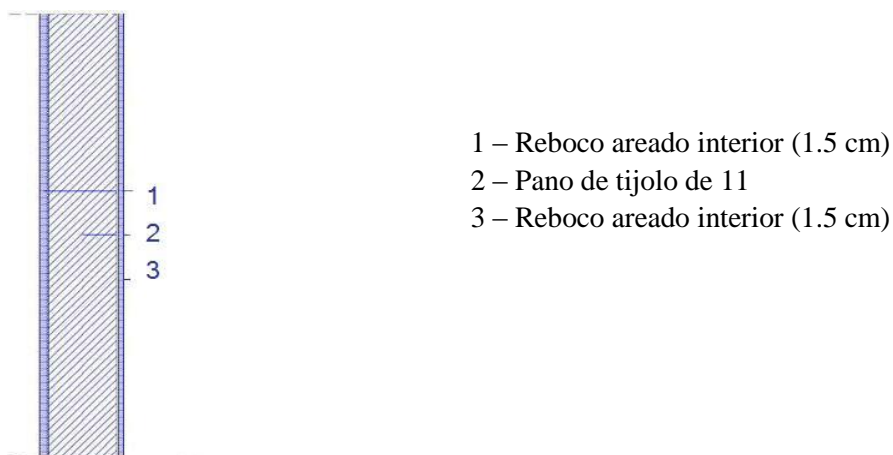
Pormenor construtivo da parede interior de alvenaria de tijolo
